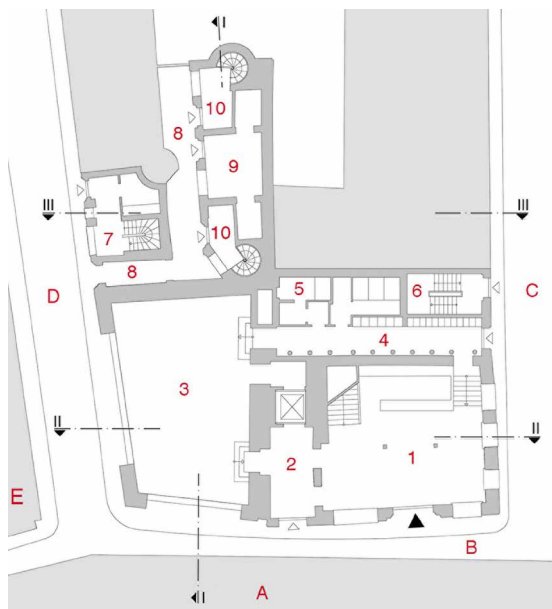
Figurentheater; Grundriss Erdgeschoss [© Konermann Sigmund Architekten BDA Stadtplaner]
